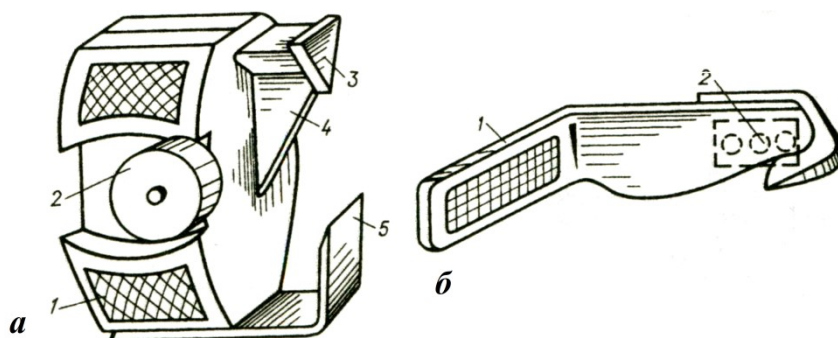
Ножі для прирізування шпалер: а, б - відповідно з однією та двома ковзними опорами; 1 - лезо; 2 - верхня опора; 3 - гайка; 4 - ручка; 5 - нижня опора
